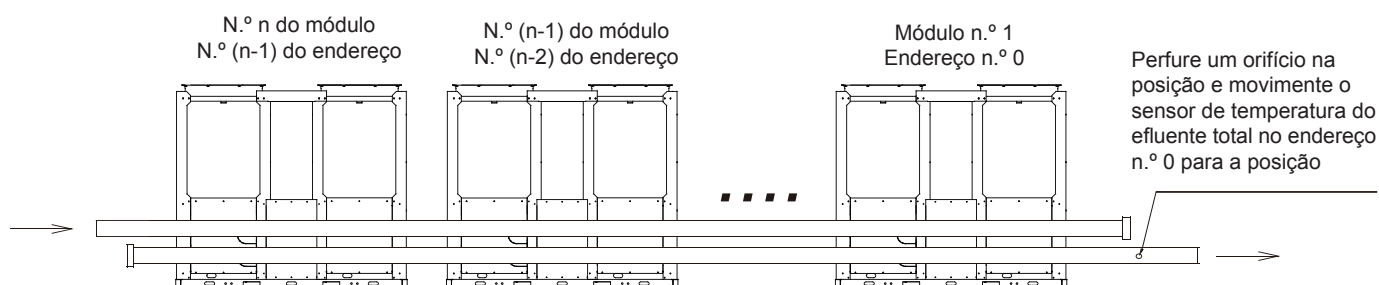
Instalação de multimodular (não mais que 8 módulos) KEM-180 DRS5 KH
